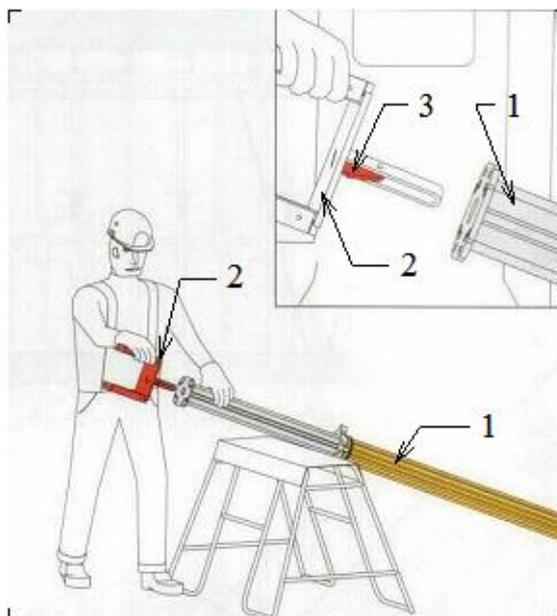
Укрупнительная сборка стойки: 1 – стойка, 2 – унивилка, 3 – пружинный фиксатор
